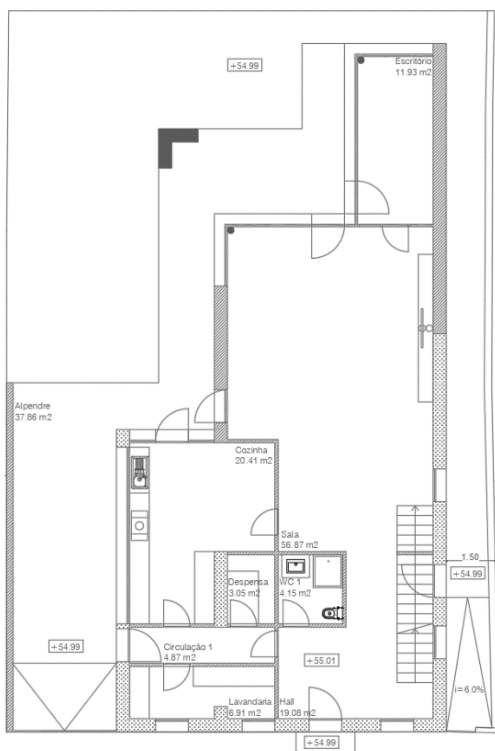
R/C planta nova (Projeto de arquitetura).
